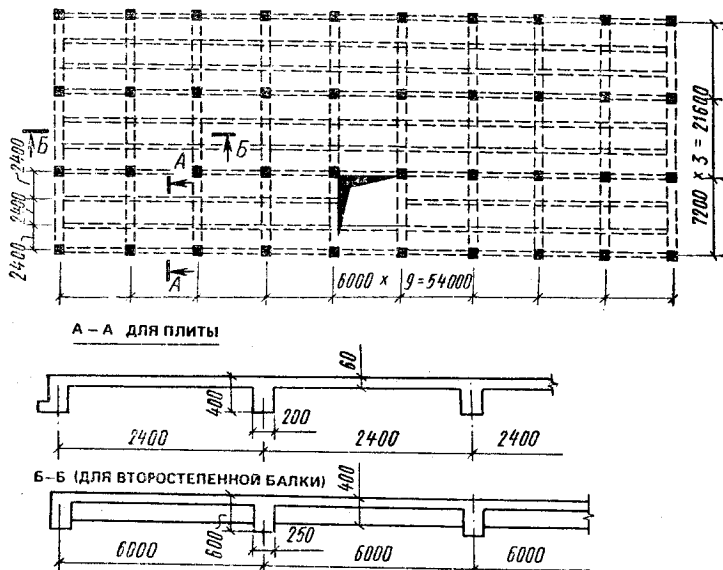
Конструктивный план монолитного ребристого перекрытия
